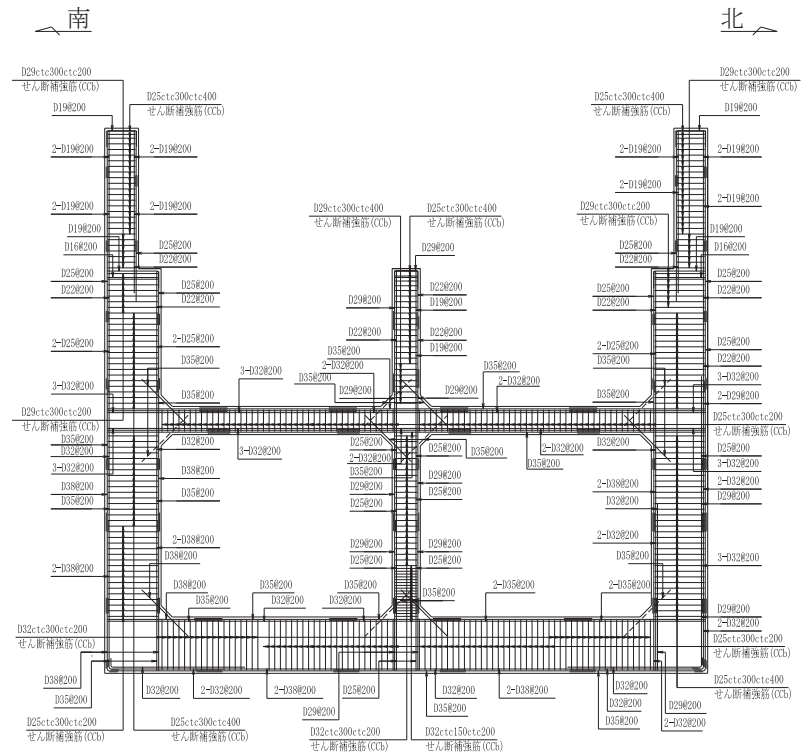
第 3 号機海水ポンプ室概略配筋図 (B-B 断面)
